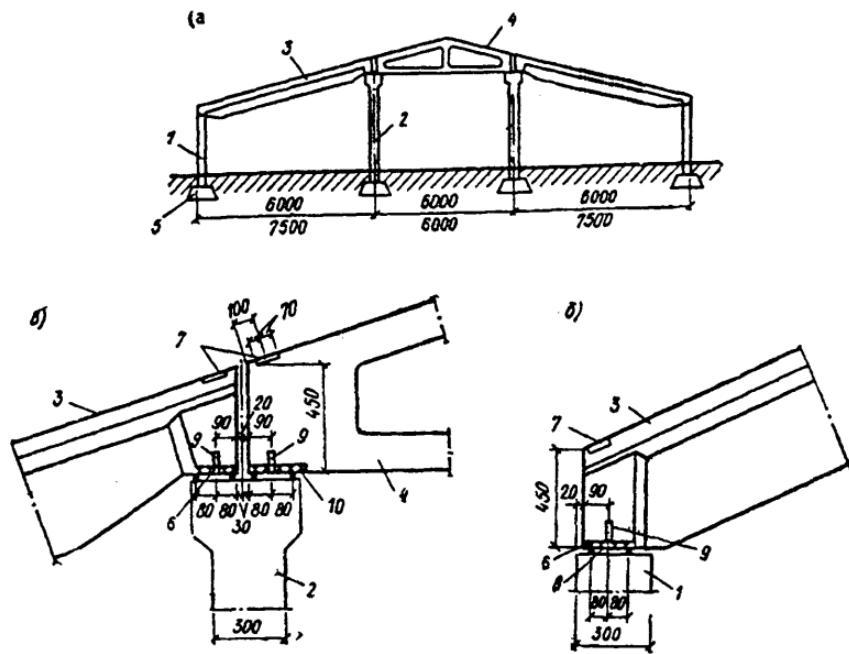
Схема железобетонного каркаса и конструктивные монтажные узлы сельскохозяйственных зданий:
